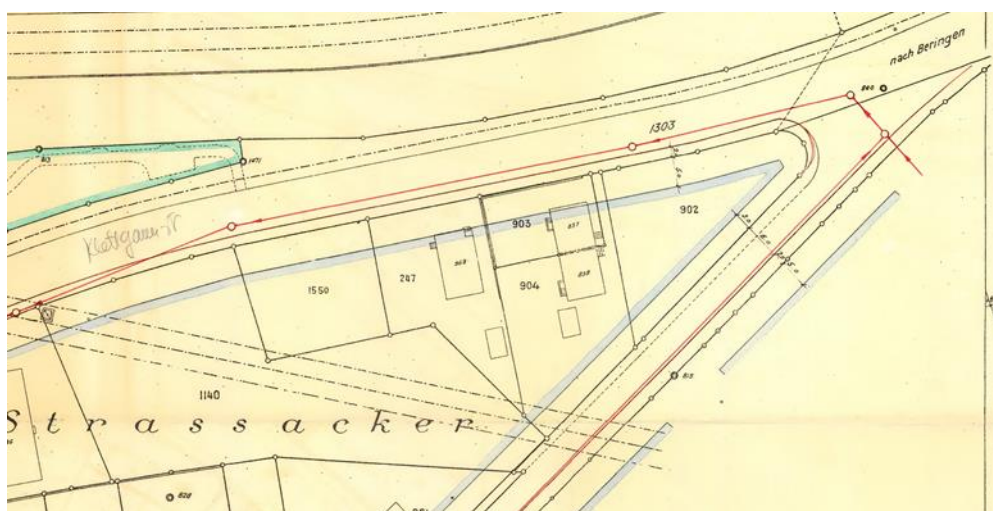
Baulinienplan Nr. 15, Ausschnitt
